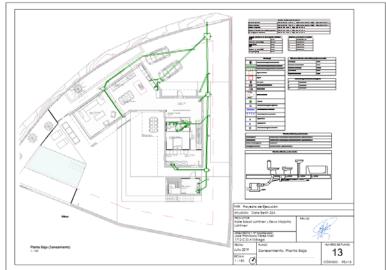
Ejemplo Planos de Ejecución (BERLIN).
